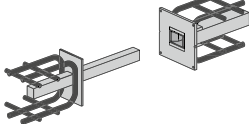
Ansicht des Unterzugs mit Bewehrungsanordnung
